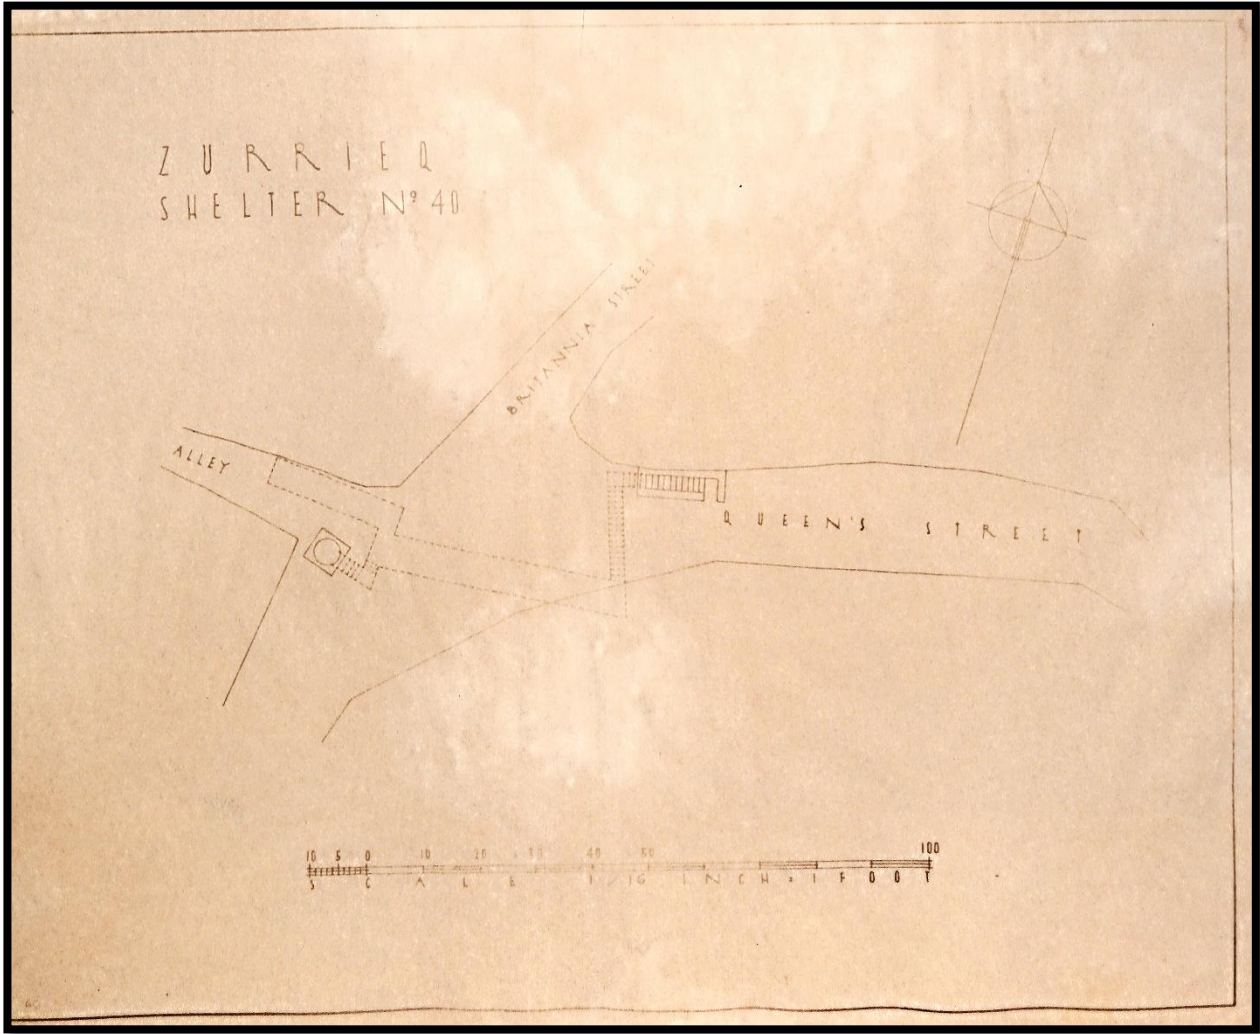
Planta do Abrigo nº 40 "Alley – Britannia Street – Street"
